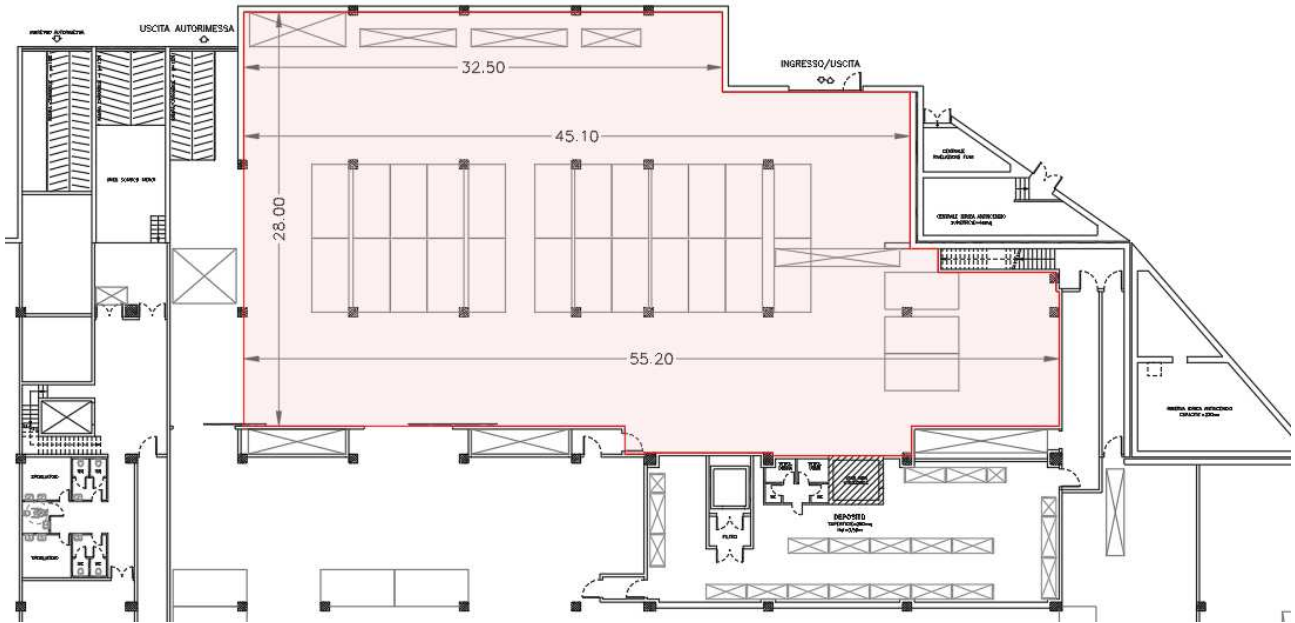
Rappresentazione planimetrica della superficie effettivamente fruibile del sub 34 (mq 1340)
